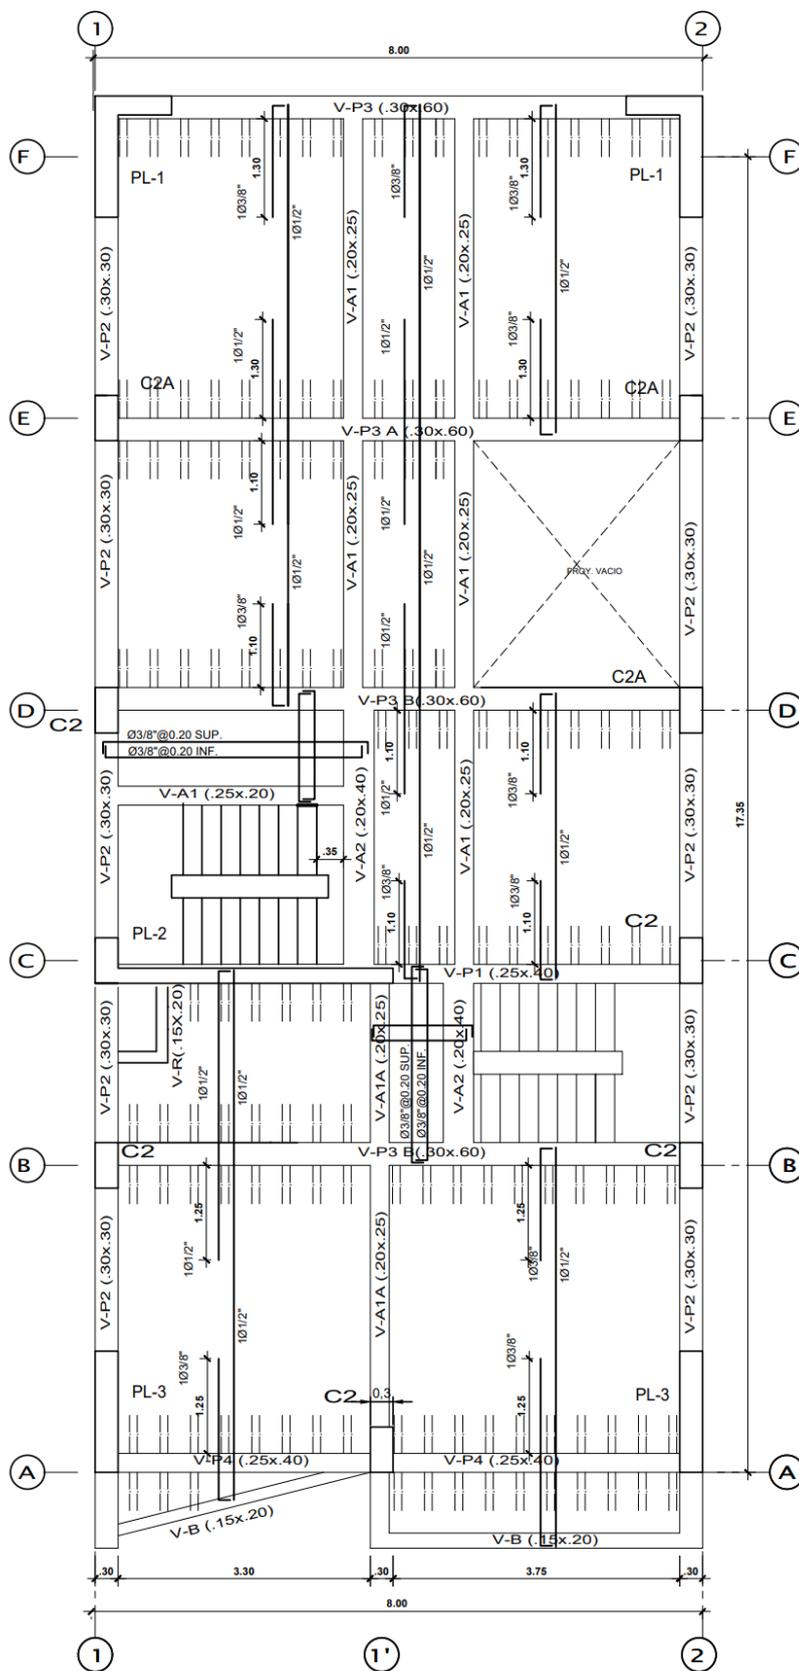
Losa aligerada del 2do piso del proyecto 1.
